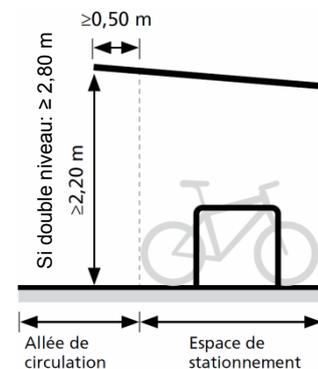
Dimensionnement des toitures (source : [16] p. 89)
